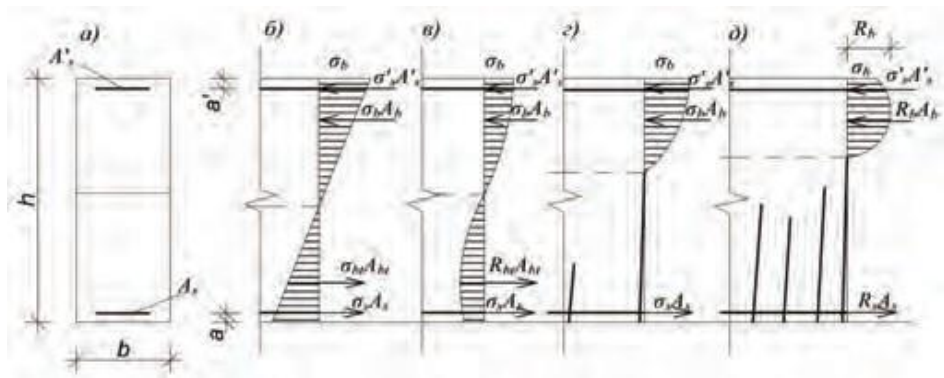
Этапы напряженно-деформированного состояния изгибаемых железобетонных элементов.
